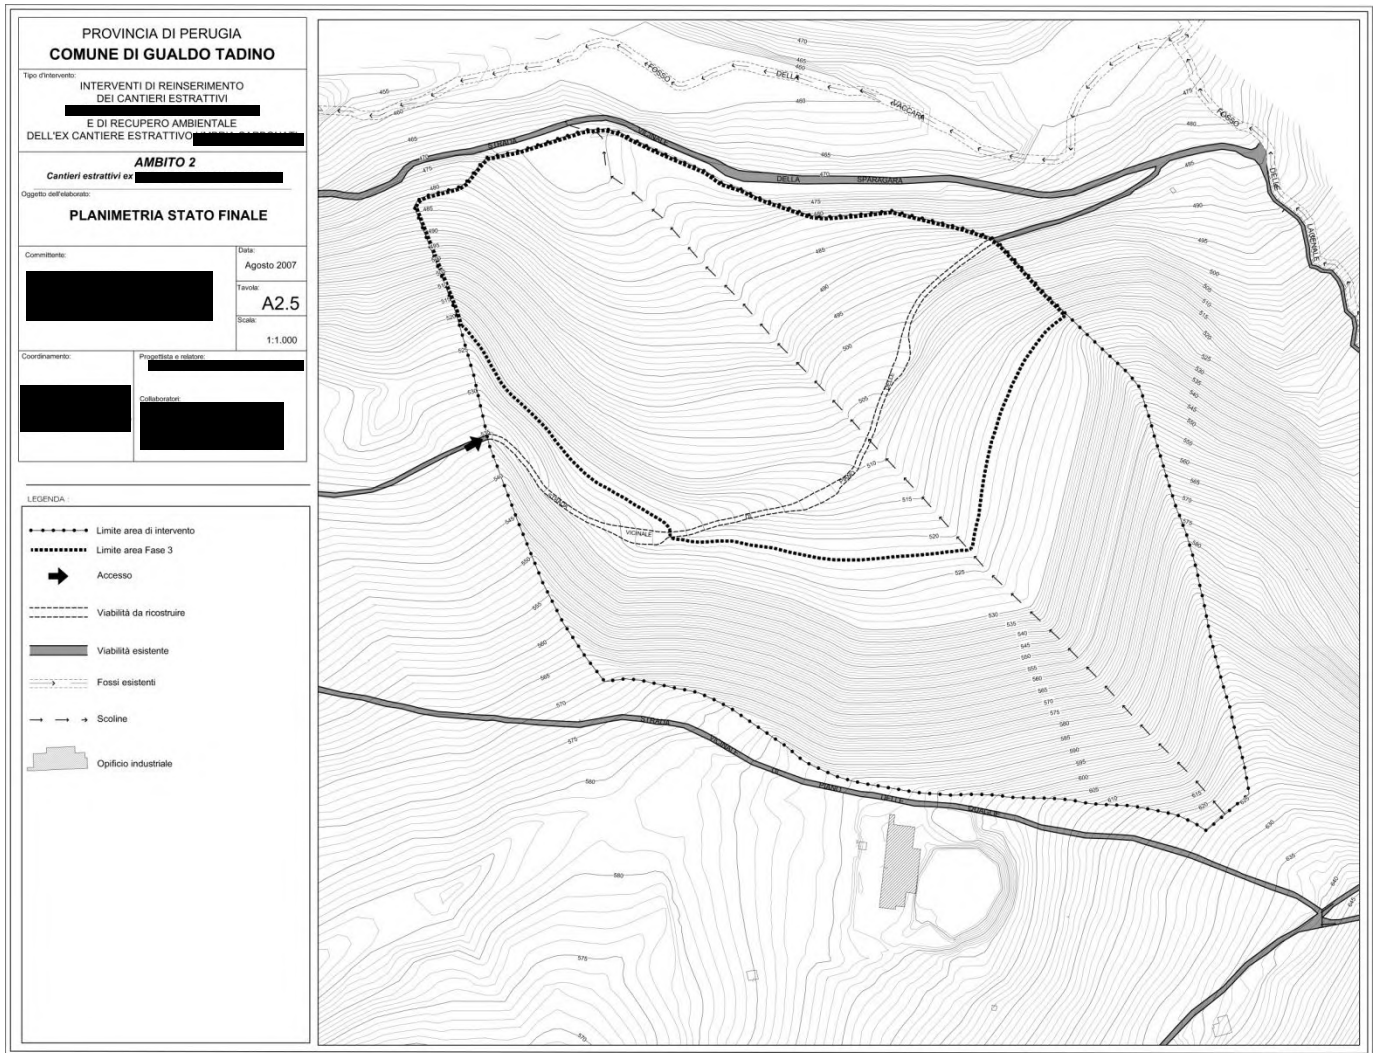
Planimetria stato finale aut. n. 1/2010
